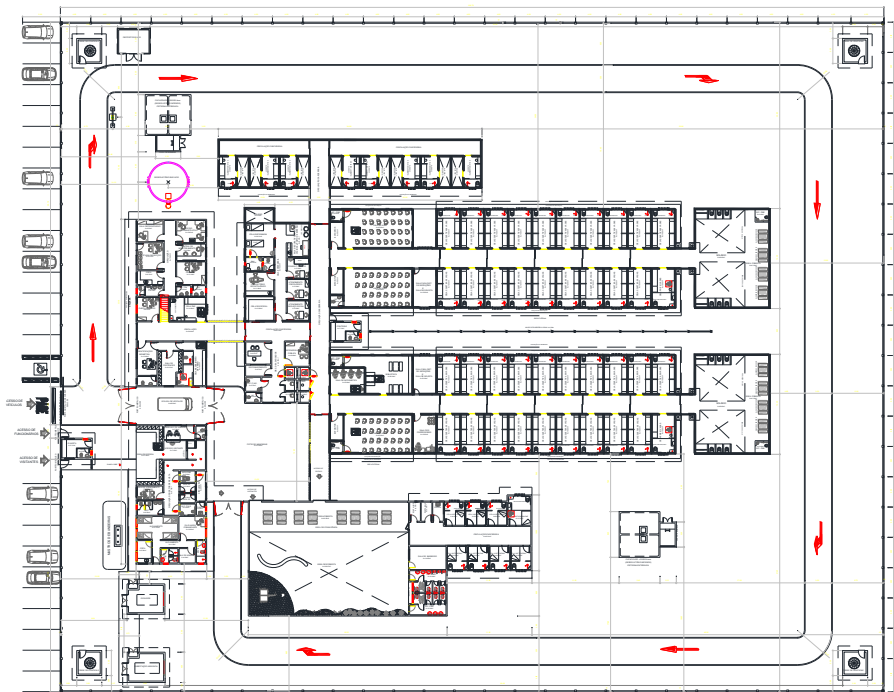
Planta baixa Pavimento Térreo projeto Pará.
